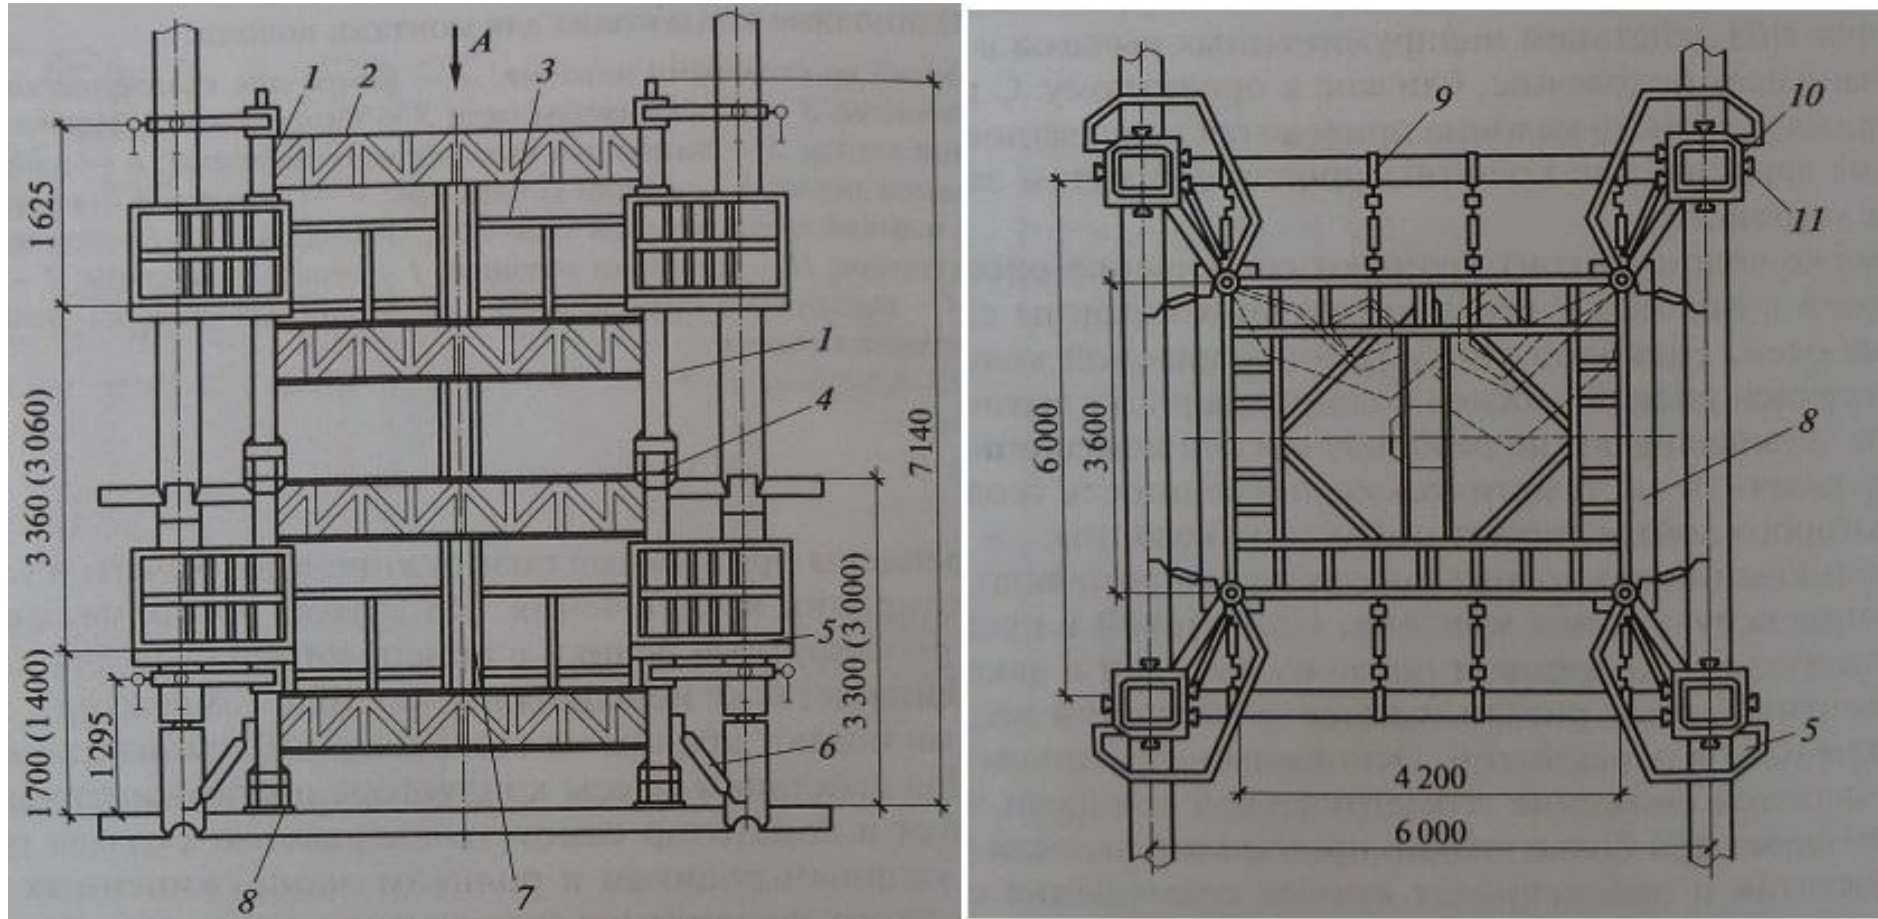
Групповой кондуктор: 1-стойки; 2-рамы; 3-ограждение; 4-вставка; 5-площадка монтажная; 6-подкос; 7-лестница; 8-подкладка; 9-струбциын со стяжкой; 10-хомут с регулировочными винтами; 11-винт.
